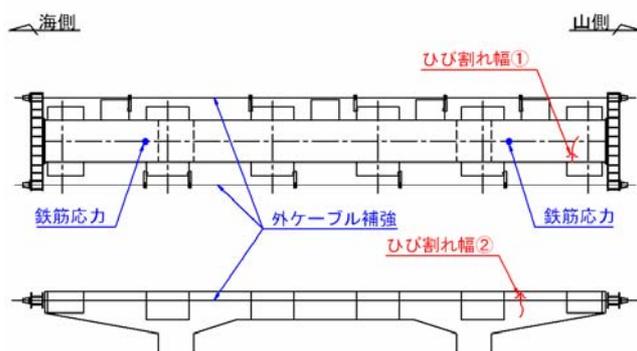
応力計測及びひび割れ変動量計測位置図 (A橋脚)
